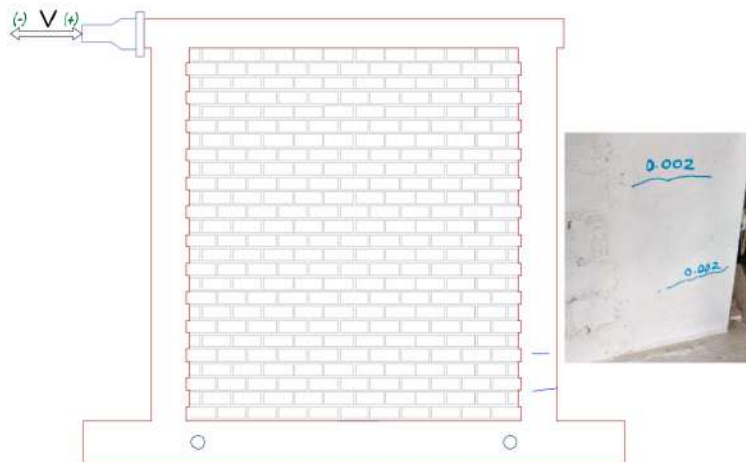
Fase 1, fisuras en el talón derecho.
